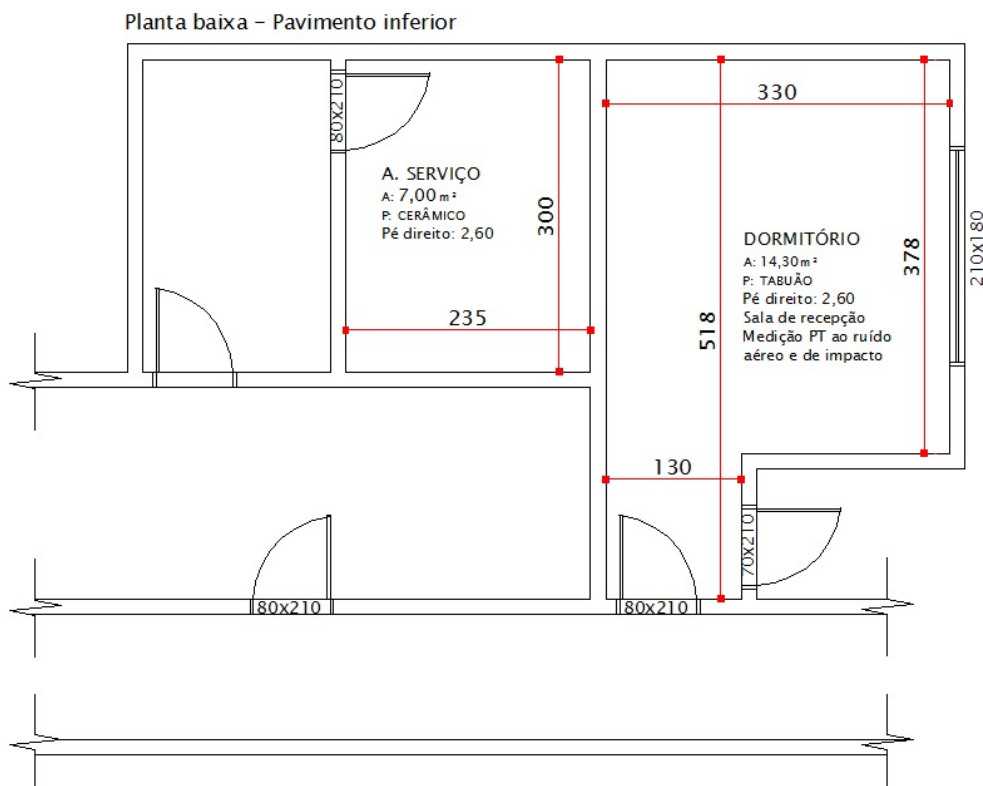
Planta baixa - pavimento inferior - 08-R8-N-TV
